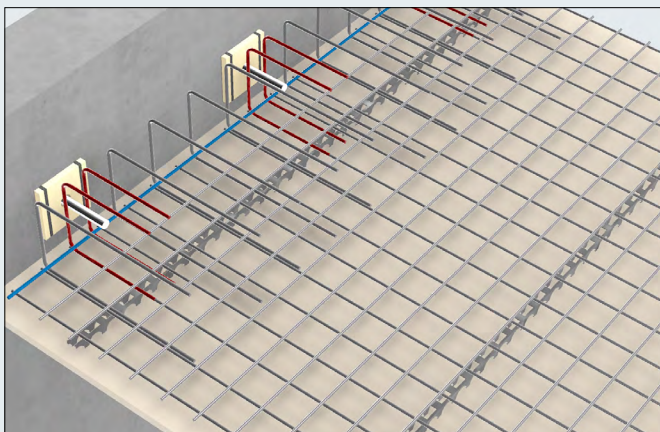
Nach dem Betonieren der Wand die untere Bewehrungslage inkl. Bügelbewehrung auf Plattenschalung verlegen, Dorne mit Brandschutzmanschette (optional) in Hülsen einschieben.
